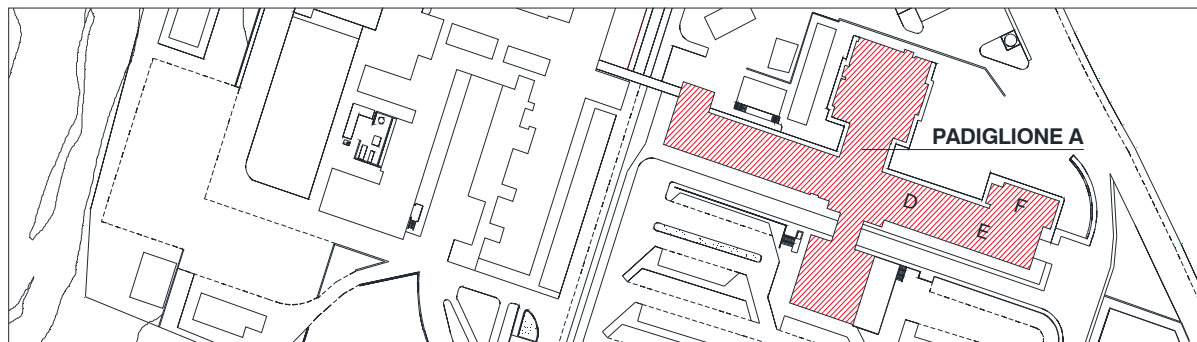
Stralcio planimetrico dell'area ospedaliera con ubicazione dell'attuale Pronto Soccorso Adulti
